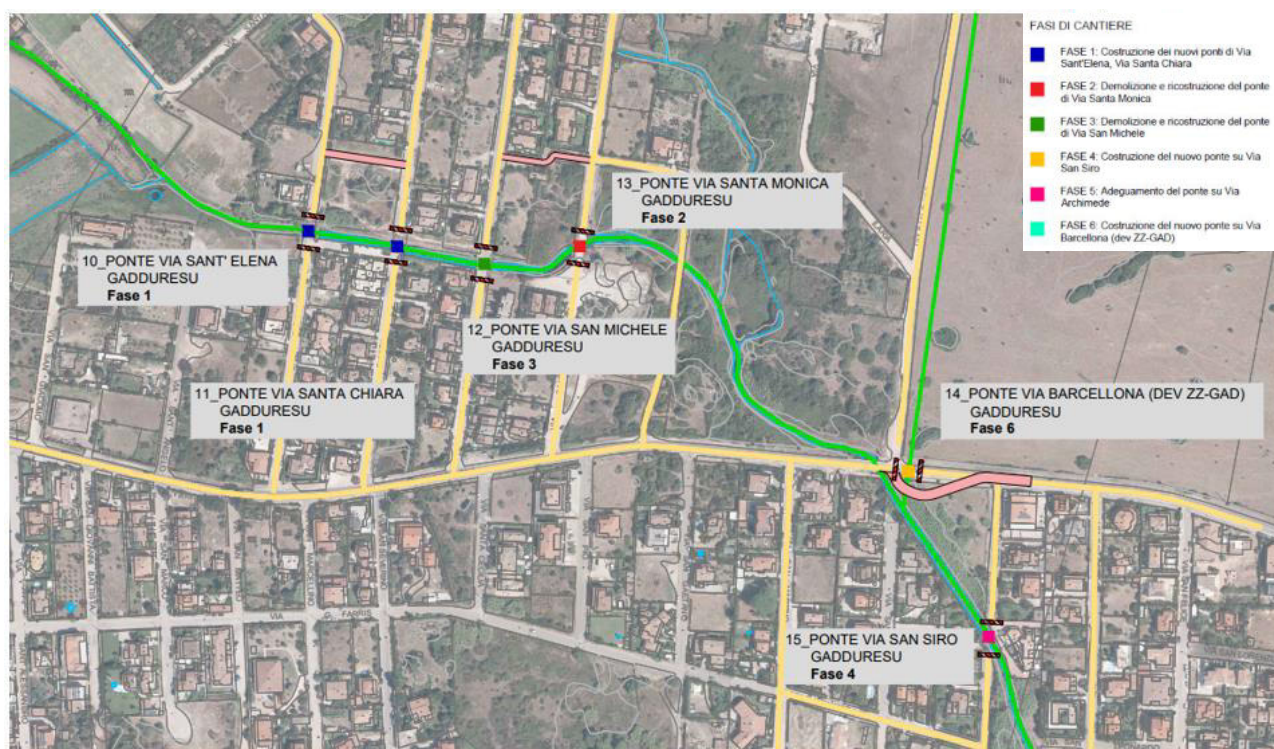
Attraversamenti cantiere 2.3 – Gadduresu-Seligheddu
